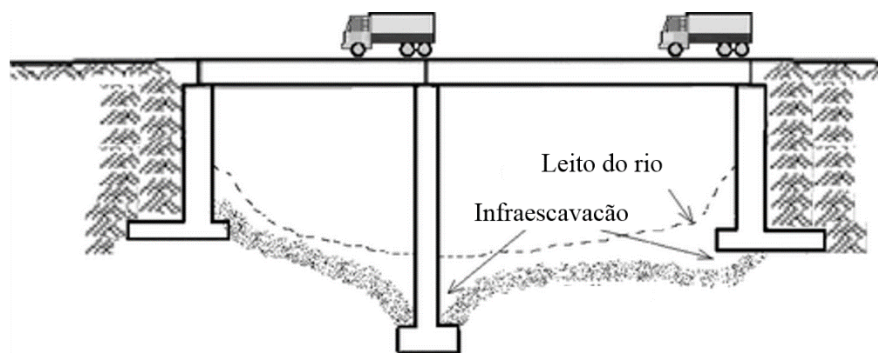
Fenómeno da infraescavação em pilares submersos [13]
